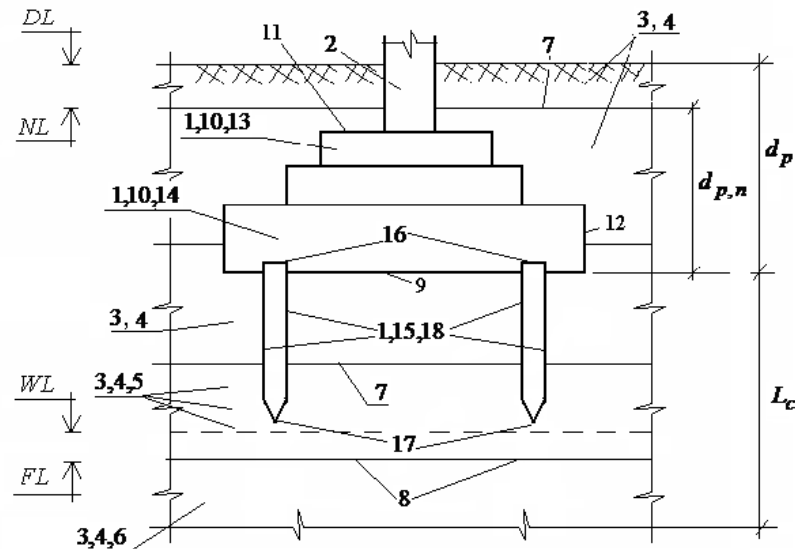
Система «основа - пальовий фундамент - надфундаментна будова (схема): 1 - фундамент; 2 - надфундаментна будова; 3 - основа; 4 - ґрунтові шари; 5 - несучий шар ґрунту; 6 - підстиляючий шар ґрунту; 7 - покрівля ґрунтового шару; 8 - підшва ґрунтового шару; 9 - підшва ростверку; 10 - ступені ростверку; 11 - верхній обріз ростверку; 12 - бічний обріз ростверку; 13 - верхній ступінь ростверку; 14 - нижній ступінь ростверку; d_p - глибина закладення підшви ростверку від рівня планування; $d_{p,n}$ - те ж саме, від рівня природного рельєфу; 15 - палі; 16 - голови палі; 17 - вістря палі і одночасно - підшва палевого фундаменту; 18 - бічна поверхня палі; L_c - довжина палі від підшви ростверку до підшви палевого фундаменту; NL - відмітка природного рельєфу; DL - планувальна відмітка; WL - відмітка рівня підземних вод
